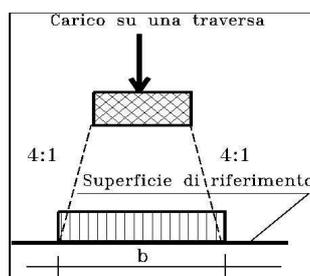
Distribuzione longitudinale dei carichi attraverso il ballast
